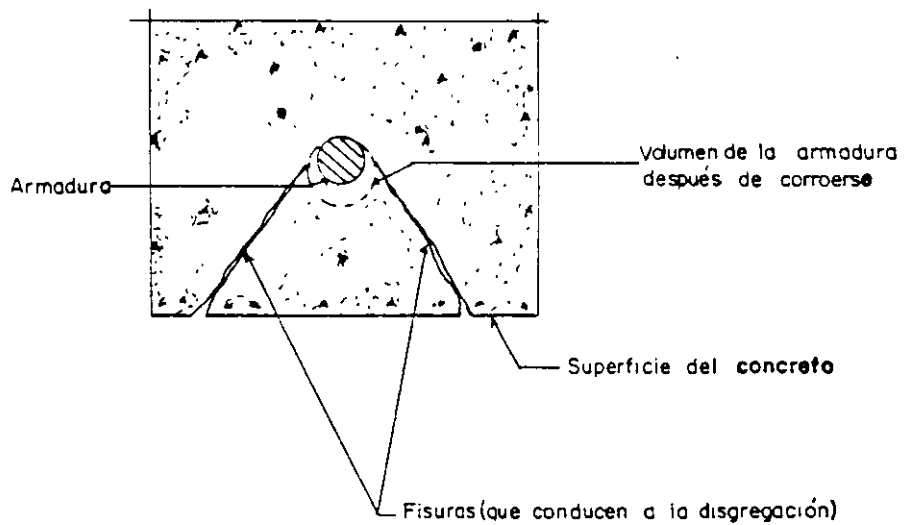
Fisuras en el concreto debidas a la corrosión de las armaduras
